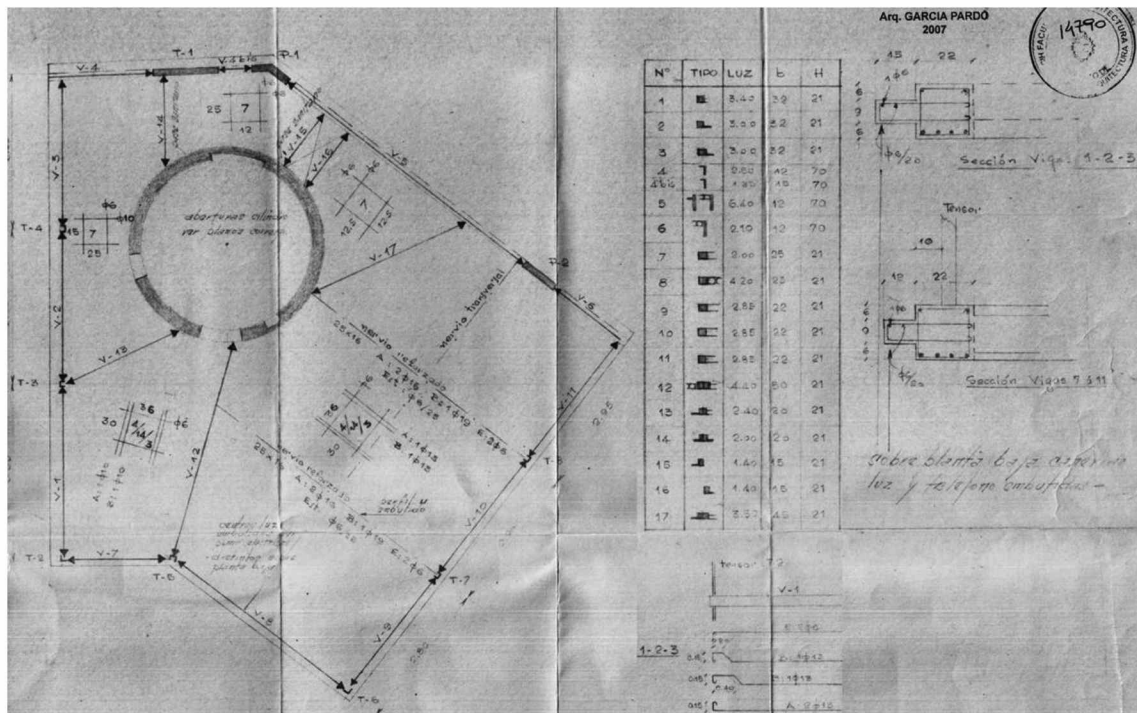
Planta tipo de estructura y detalles de las vigas de borde del edificio.
